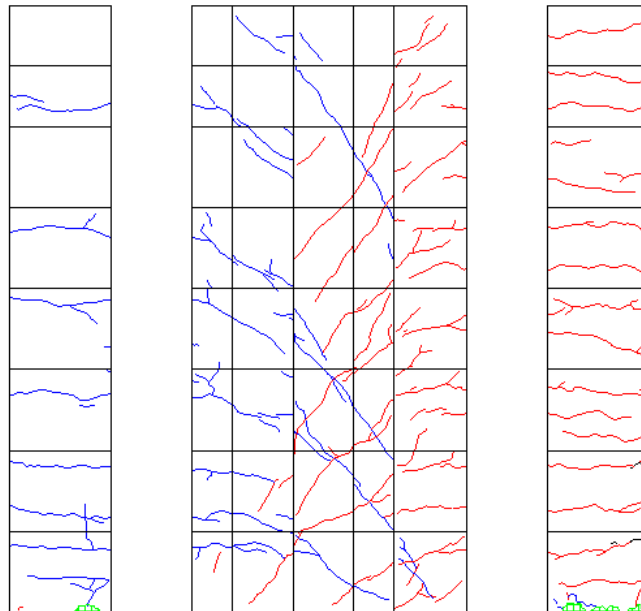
R=-1/67 ひび割れ図
